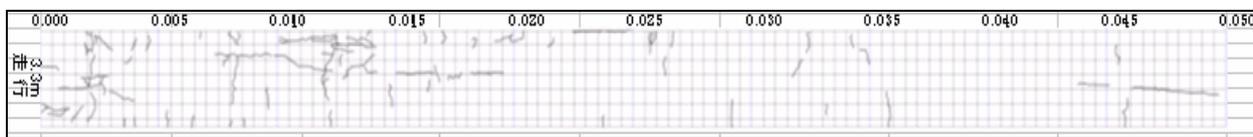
ひび割れ状況図 ②ひび割れ図
